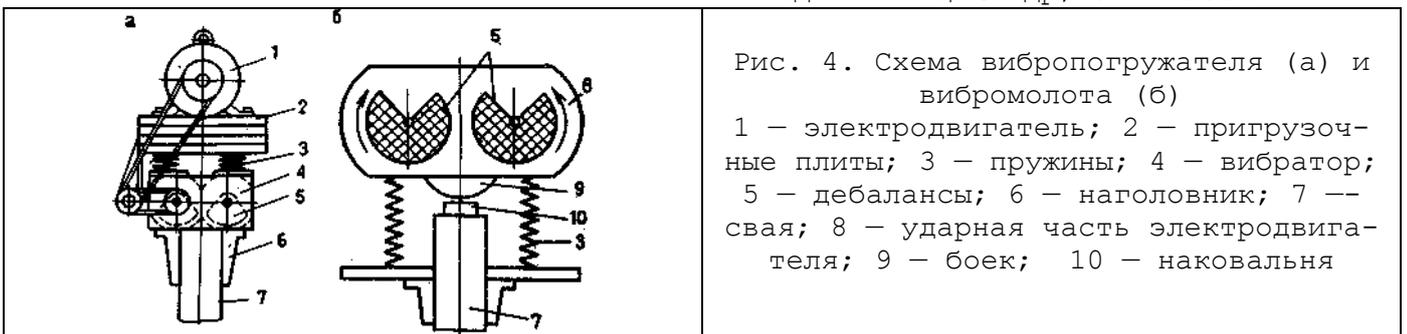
Схема вибропогружателя (а) и вибромолота (б)
